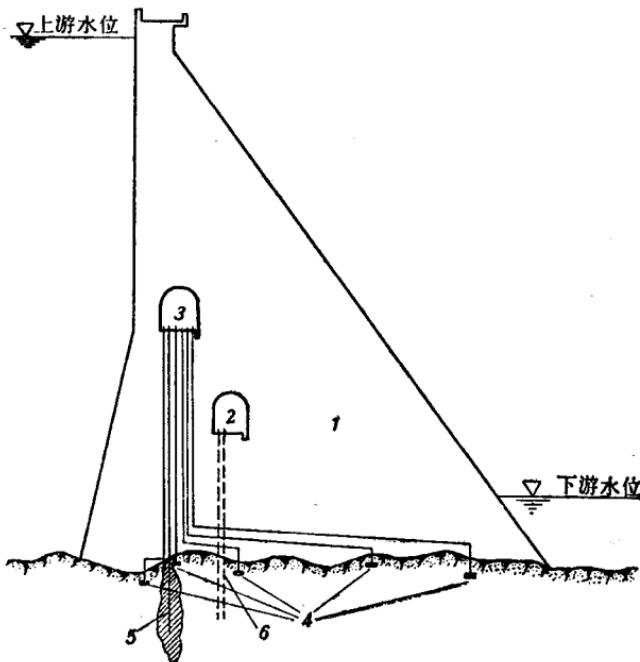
混凝土重力坝坝基揚压力測压管布置示意图
